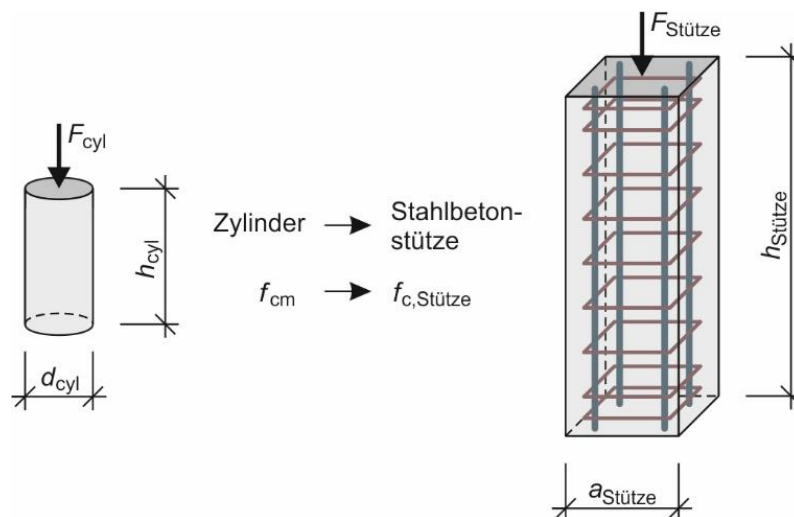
Gegenüberstellung eines unbewehrten Betonzylinders und einer Stahlbetonstütze
